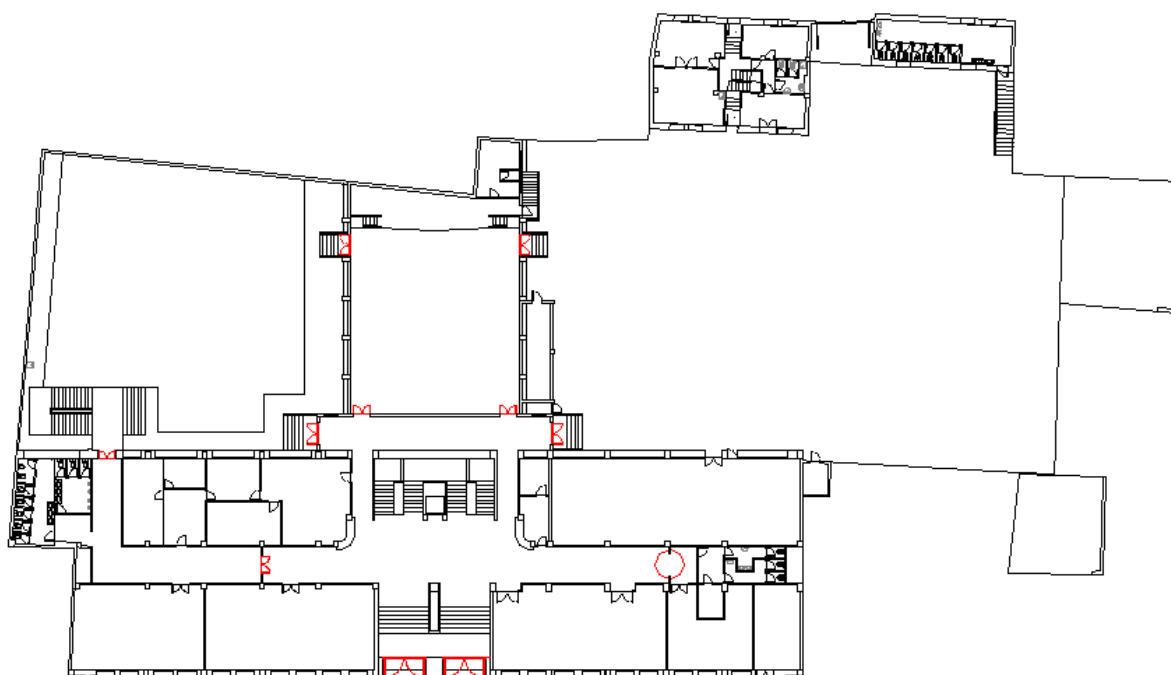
Puertas situadas en recorrido de evacuación en planta baja. Fuente: Elaboración propia.
